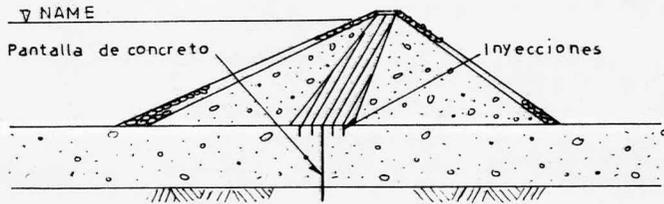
Pantalla de pilotes o muros, de concreto simple.
